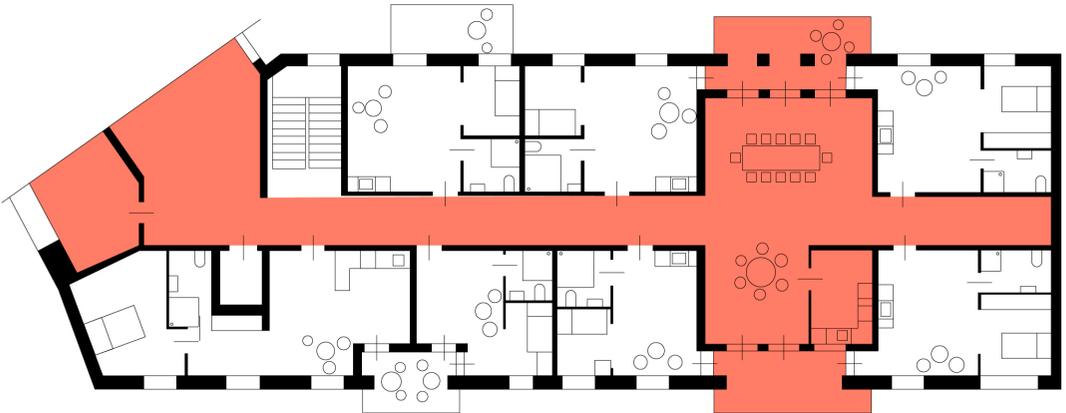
Beginnhof, Grundriss Gruppenwohnung
